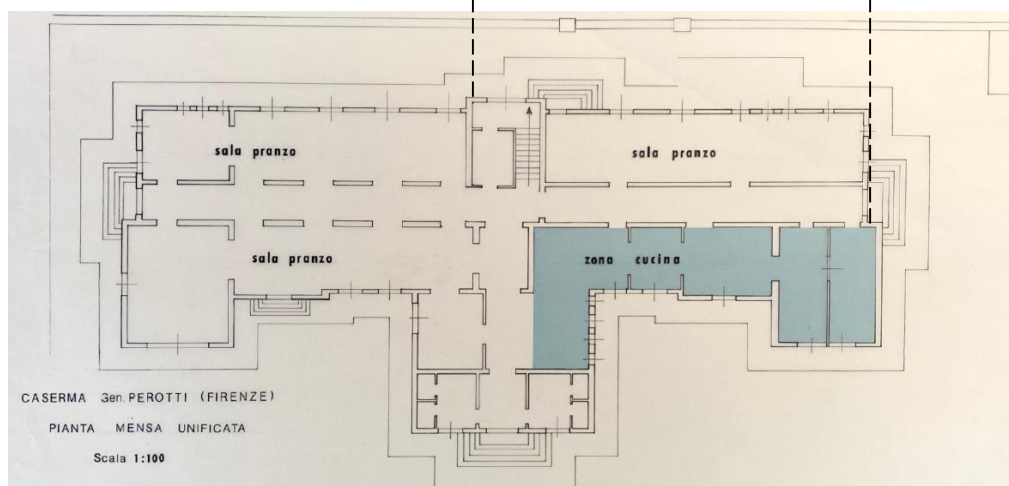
Pianta piano terra - distribuzione con funzione di mensa.
